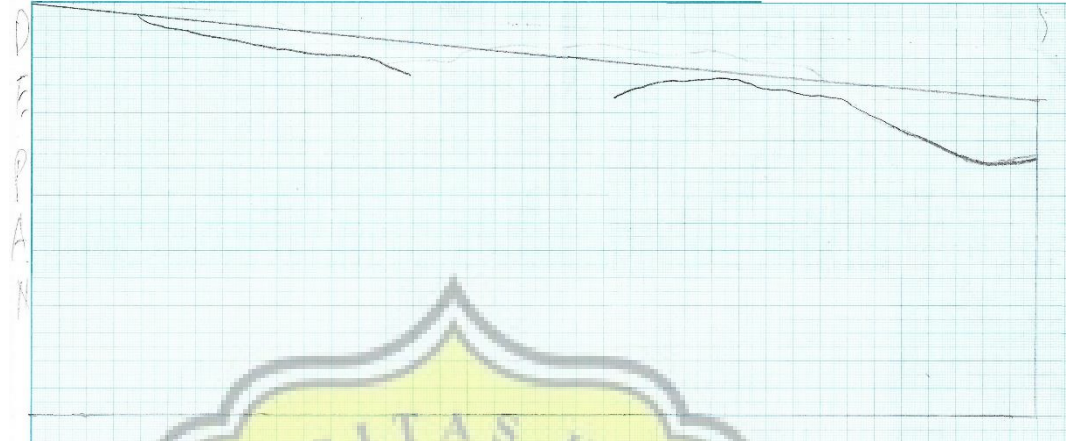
Penurunan permukaan blok beton benda uji KTB-SC-03
